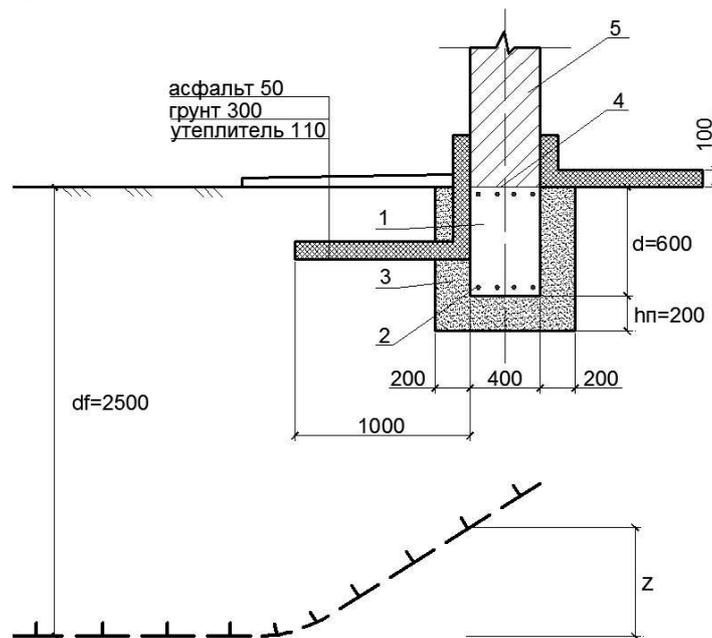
Малозаглубленный фундамент с утепленной отмосткой: 1 – ленточный фундамент; 2 – арматура; 3 – песчаная подушка; 4 – гидроизоляция; 5 – кирпичная кладка.
